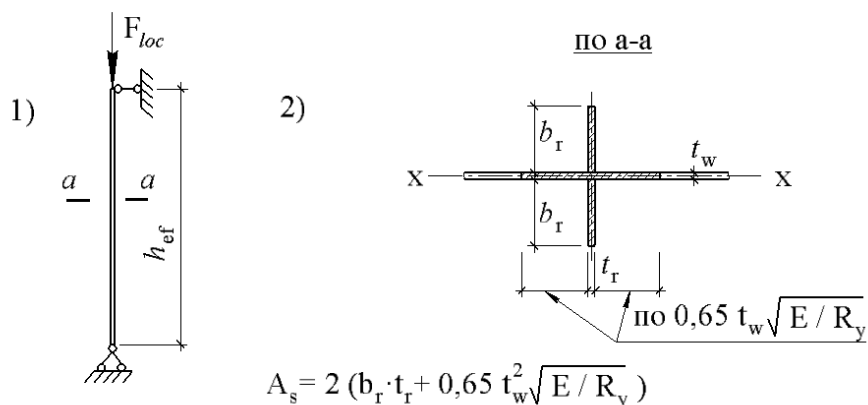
К расчету на устойчивость двухстороннего поперечного ребра жесткости в стенке балки под локальной нагрузкой:
